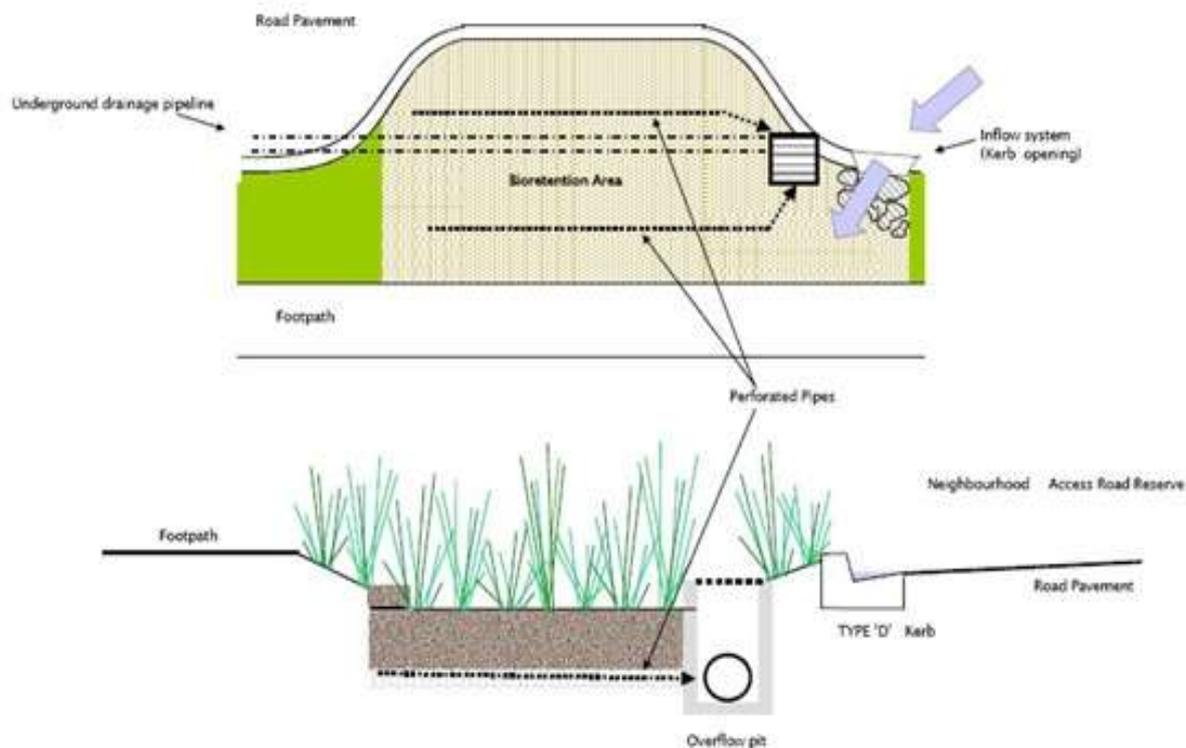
Planta e corte longitudinal de uma bacia biorretentora
